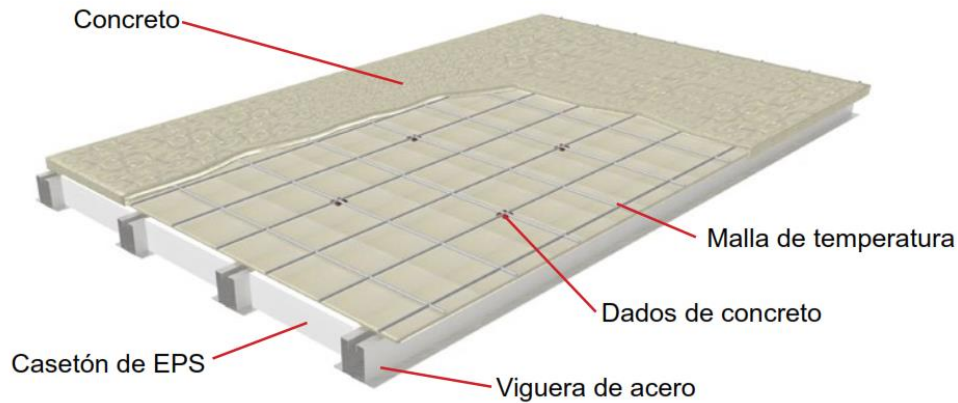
Losa aligerada con VIGACERO. Recuperado del Manual VIGACERO (2016).
